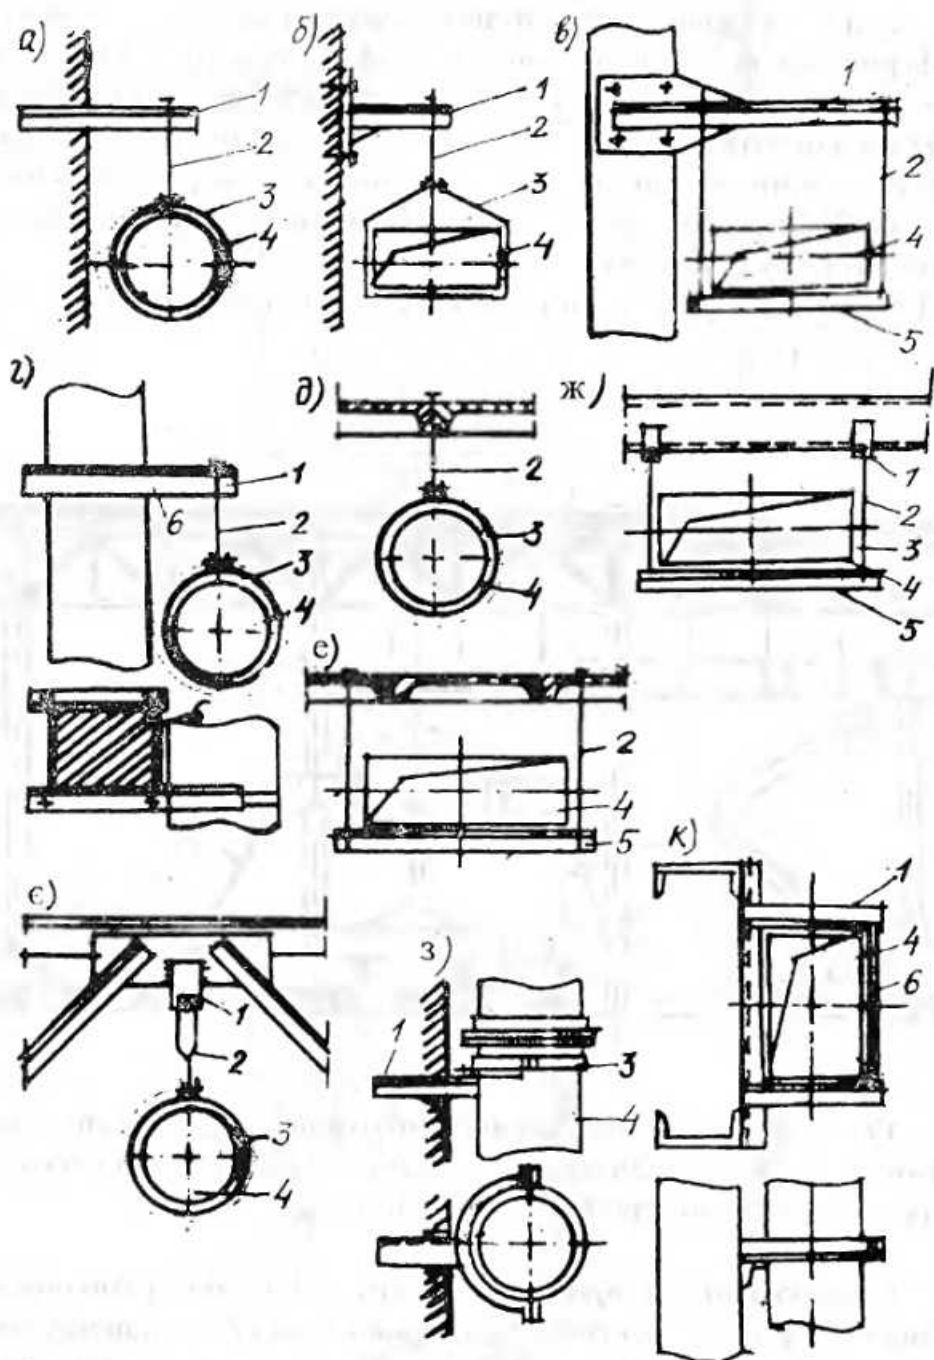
Кріплення горизонтальних і вертикальних повітропроводів до будівельних конструкцій: а,б - до стін; в,г - до колон; д,е - до перекриттів; е,ж - до ферм і прогонів; з - вертикальних повітропроводів до стін і до колон (к); 1 - консоль; 2 - тяга; 3 - кріпильний хомут; 4 - повітропровід; 5 - траверса; 6 - стягувальний болт
